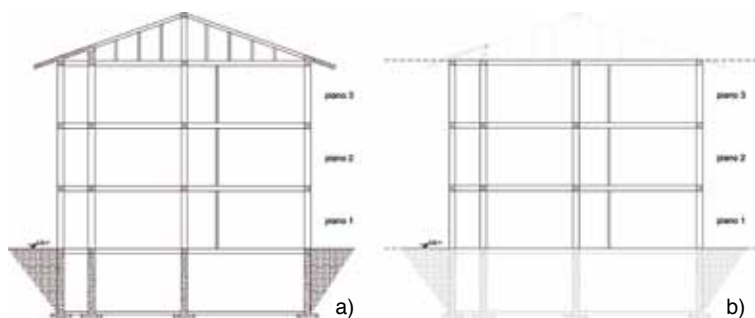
Schema strutturale di un edificio con struttura interrata in c.a. e copertura a muretti e tavelle, portati dal solaio piano di sottotetto. a) Sezione edificio; b) Sezione considerata nella modellazione
